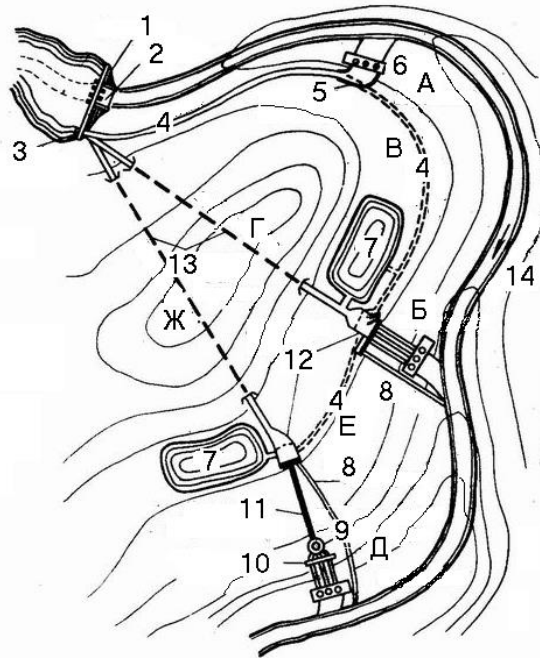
План гідровузла: 1 – гребля; 2 – водоскид; 3 – водосприймач, 4 – канал; 5 – напірний басейн; 6 – будівля ГЕС (варіант А); 7 – БДР; 8 – водоскид; 9 – водоскид; 10 – приміщення затворів; 11 – напірний трубопровід; 12 – напірний басейн; 13 – безнапірний тунель; 14 – русло річки
